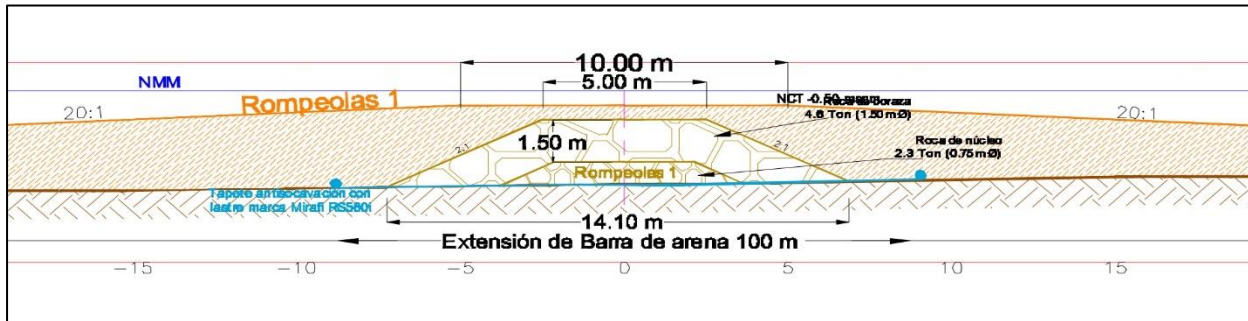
Sección tipo del Rompeolas 1 con núcleo de roca.
